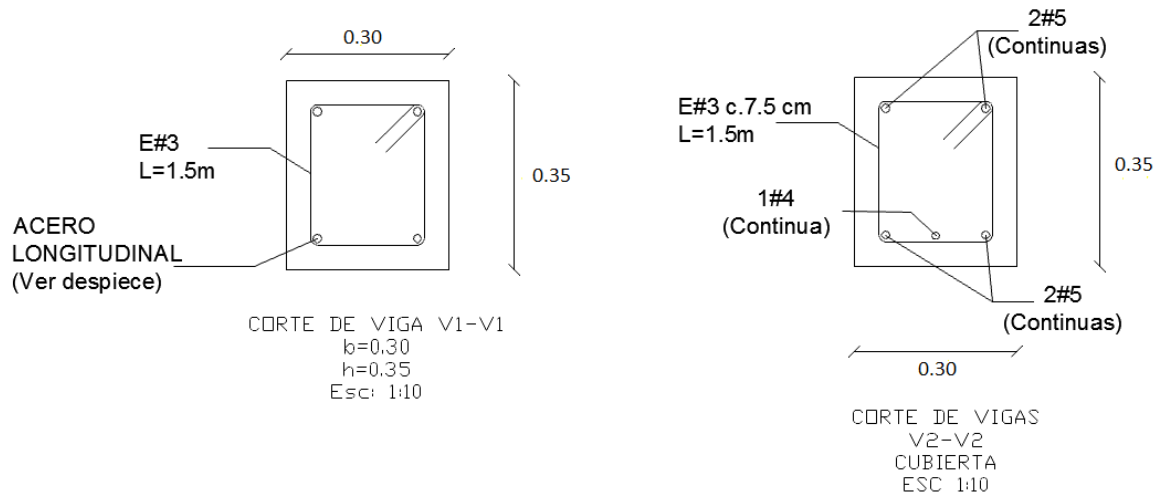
Planos de corte transversal en viguetas V1 y V2.
